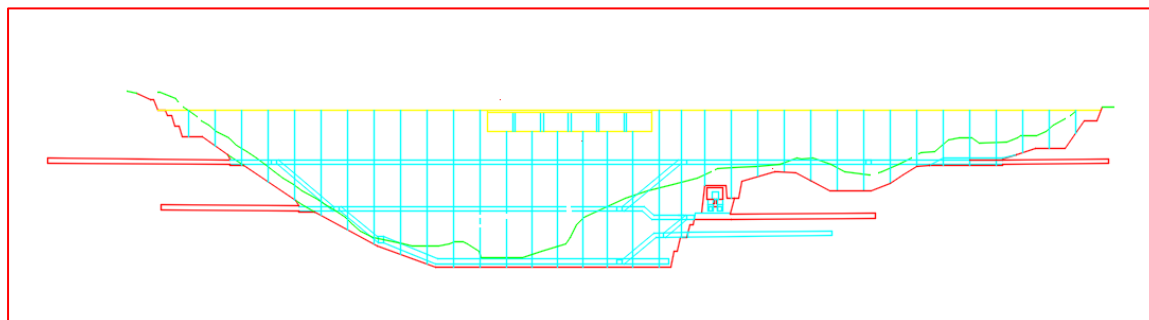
Coupe longitudinale du barrage de Béni-Haroun
